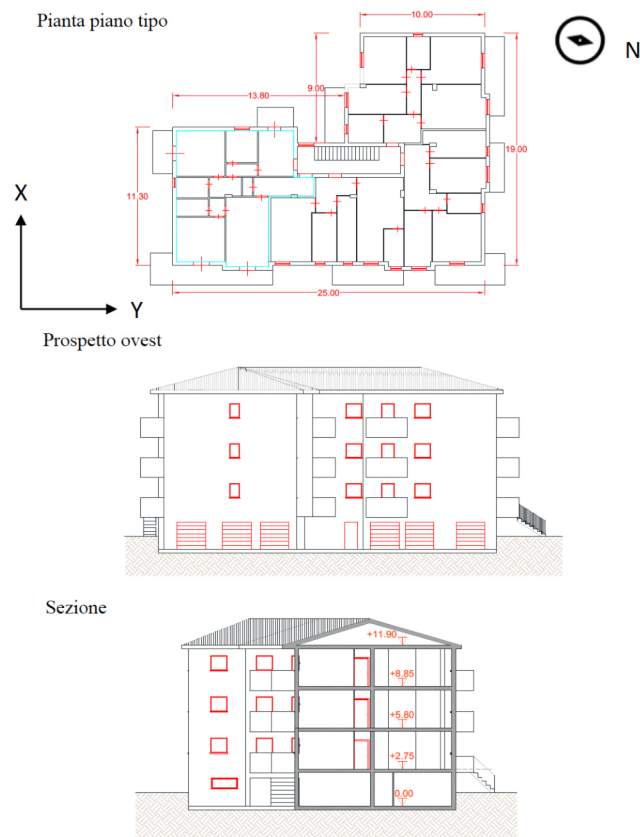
Pianta, prospetto e sezione Condominio Santarelli 2A
